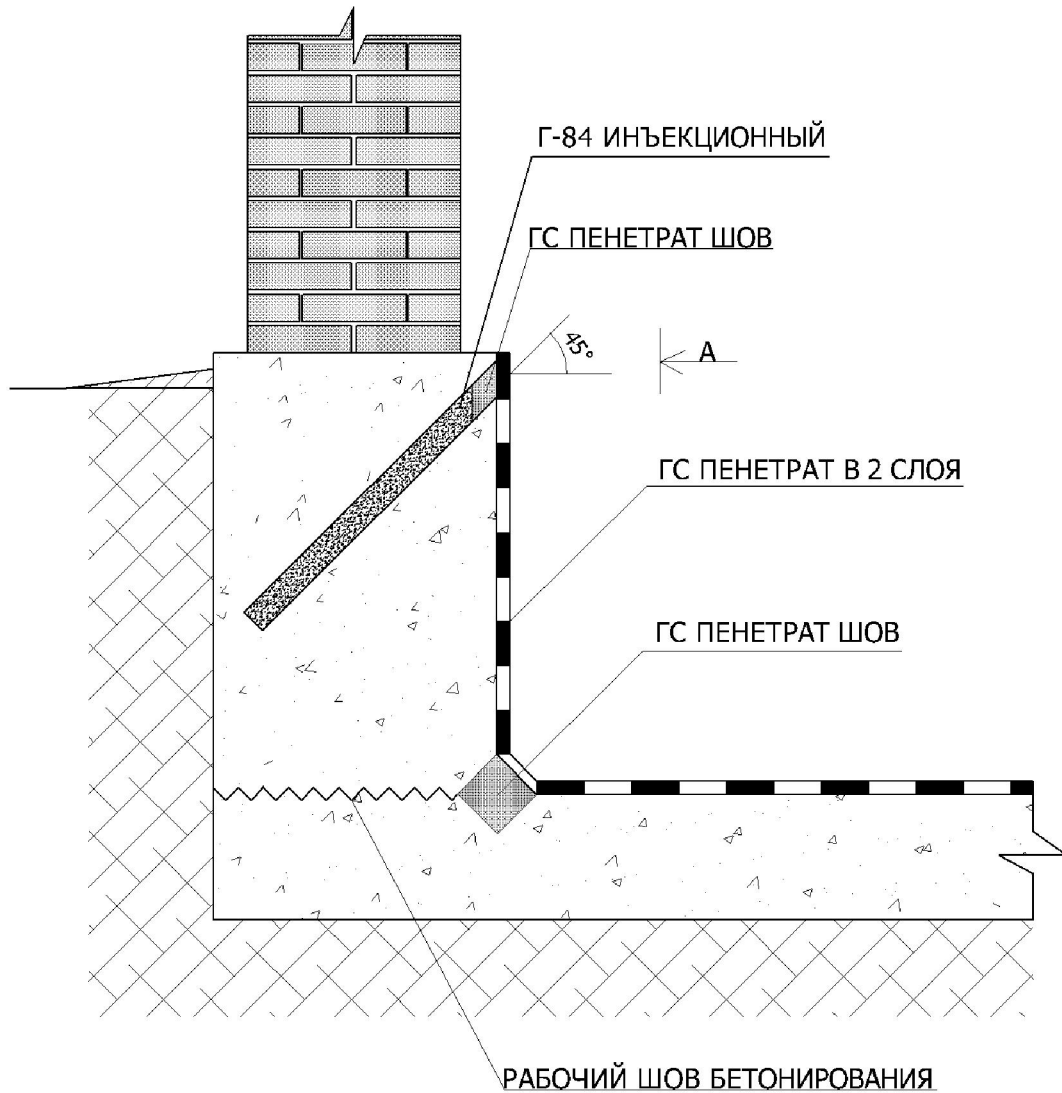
Гидроизоляция бетонного фундамента и отсечение капиллярного подсоса между бетонным фундаментом и стеной, выполненной из пористого материала, в строящейся конструкции
